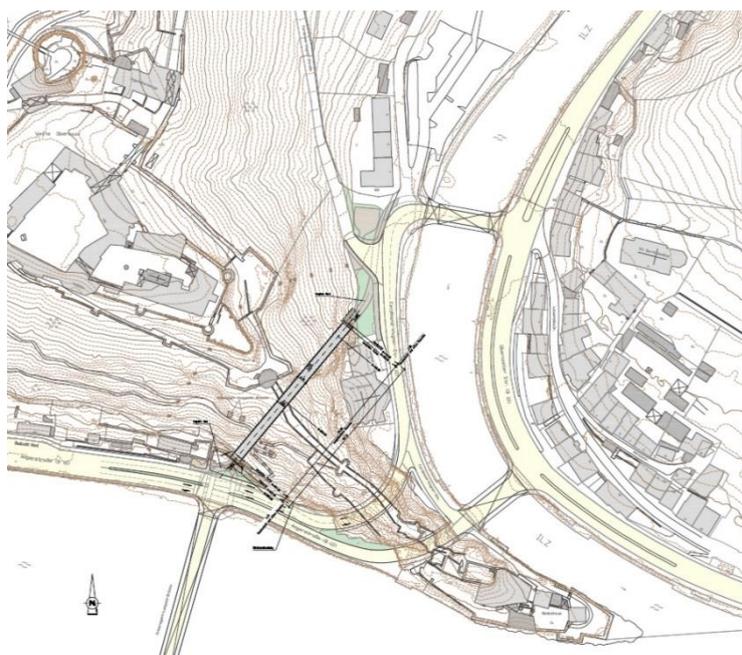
Fahrradunnel Georgsberg, Lageplan (Entwurf EDR, NOV 2012)
